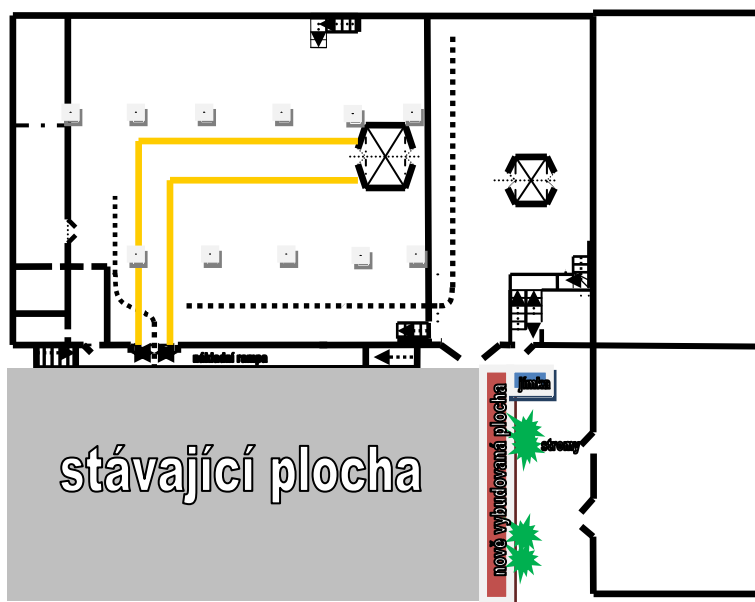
půdorysné schéma stávajícího stavu Hlavního skladu
